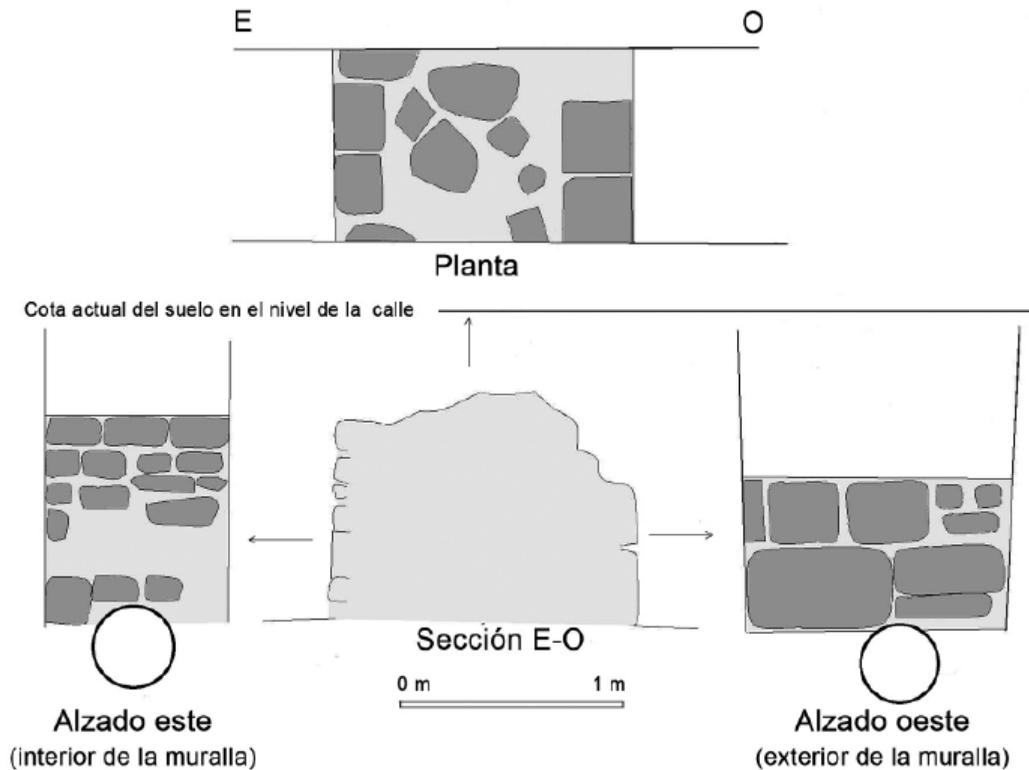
Planta, sección y alzados del fragmento de muralla localizado en la plaza Cortes de Aragón.
